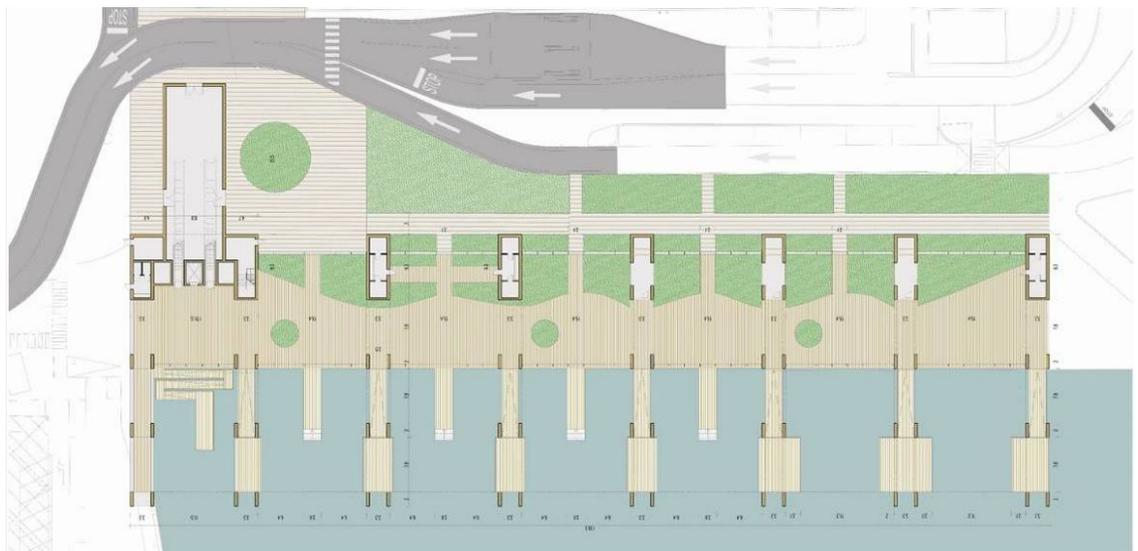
Pianta dell'edificio presso la darsena: piano terra.
